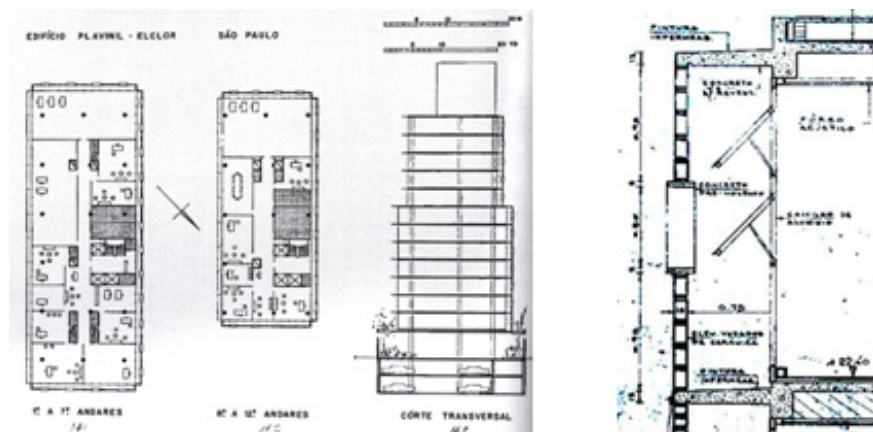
Detalhes do posicionamento do plano de cobogós destacado da edificação e a abertura das janelas. Edifício Plavinil Elclor, São Paulo, Brasil, projeto de Rino Levi, construído em 1.961/1.964.
